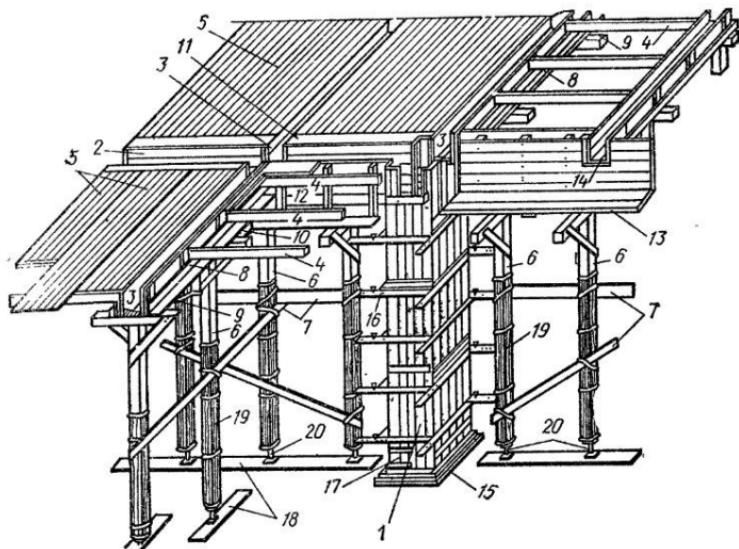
Опалубка для монолитного железобетонного ребристого перекрытия
